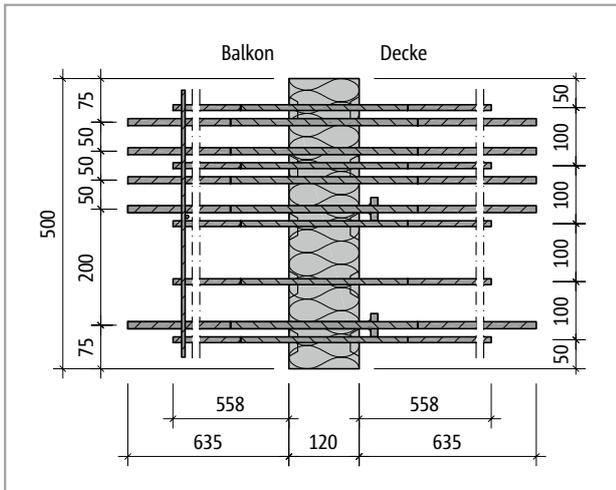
Schöck Isokorb® XT Typ C-L-M1-V1: Produktgrundriss
